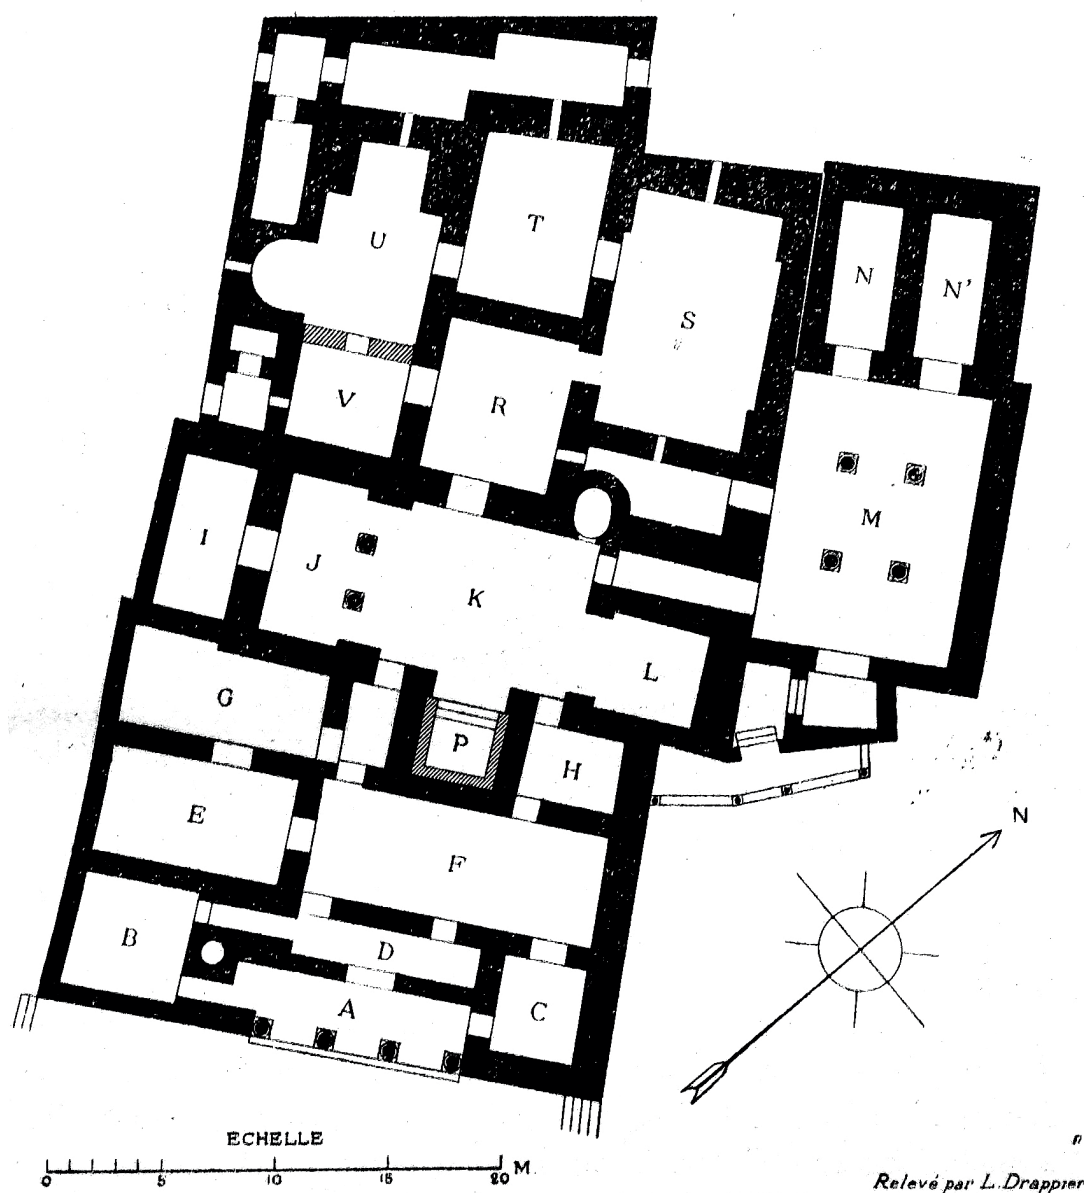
Pianta delle Thermae d'Hiver di *Thuburbo Maius*, da Drappier (1920).
